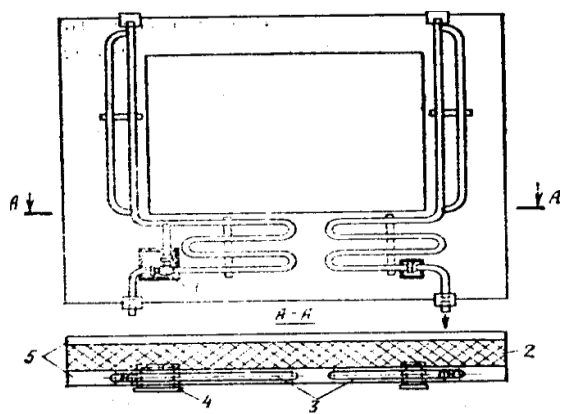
Бифилярный стояк и греющие элементы змеевиковой формы, совмещенные с трехслойной наружной стеной.
